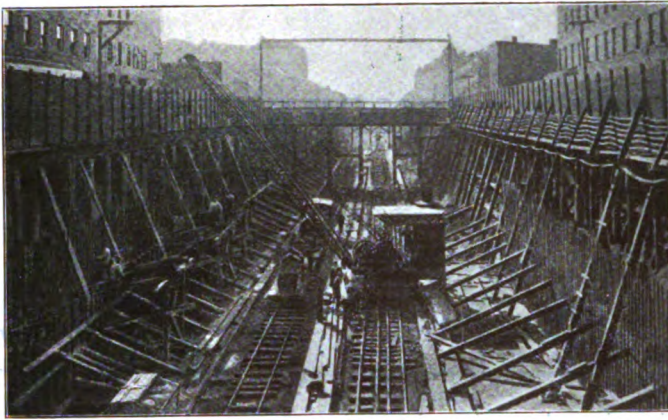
Bau der IV. Avenue-Untergrundbahn in Brooklyn. Blick in die abgesteifte Baugrube; im Hintergrunde bewegliche, eiserne Schalungsgerüste zur Betonierung des Tunnels.
